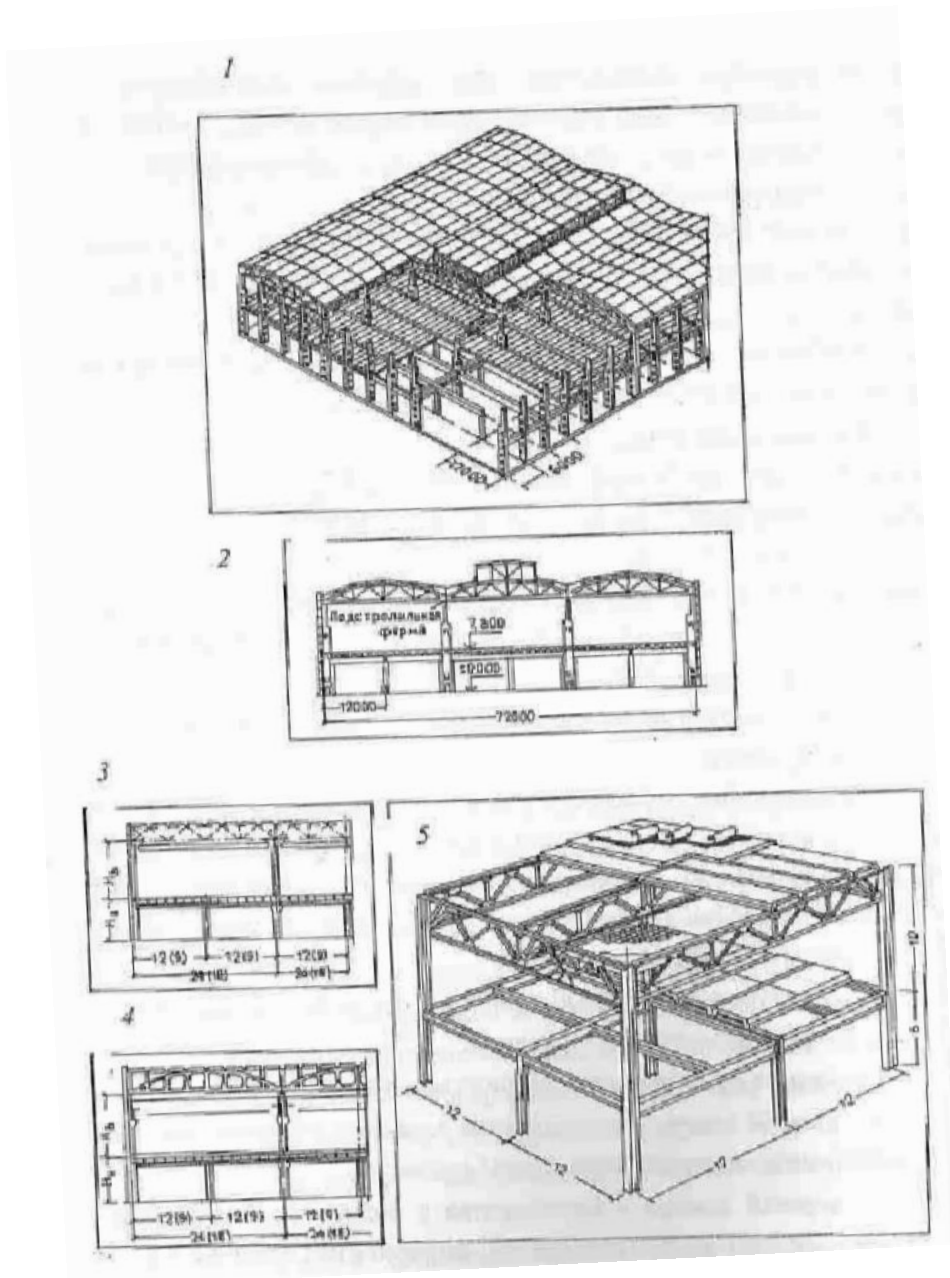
Двоповерхові промислові будівлі: 1- зальний вигляд; 2 – поперечний розріз. Двоповерхова промислова будівля з крупною сіткою колон: 3 – розріз будівлі з підвісним краном; 4 – розріз з опорним мостовим краном, 5 – фрагмент конструктивного рішення сталюого каркасу.
